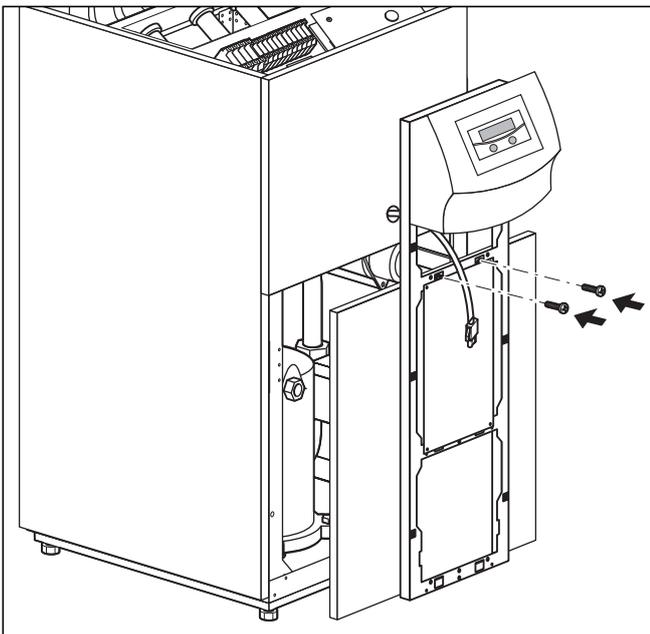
Montar la parte superior del revestimiento frontal
